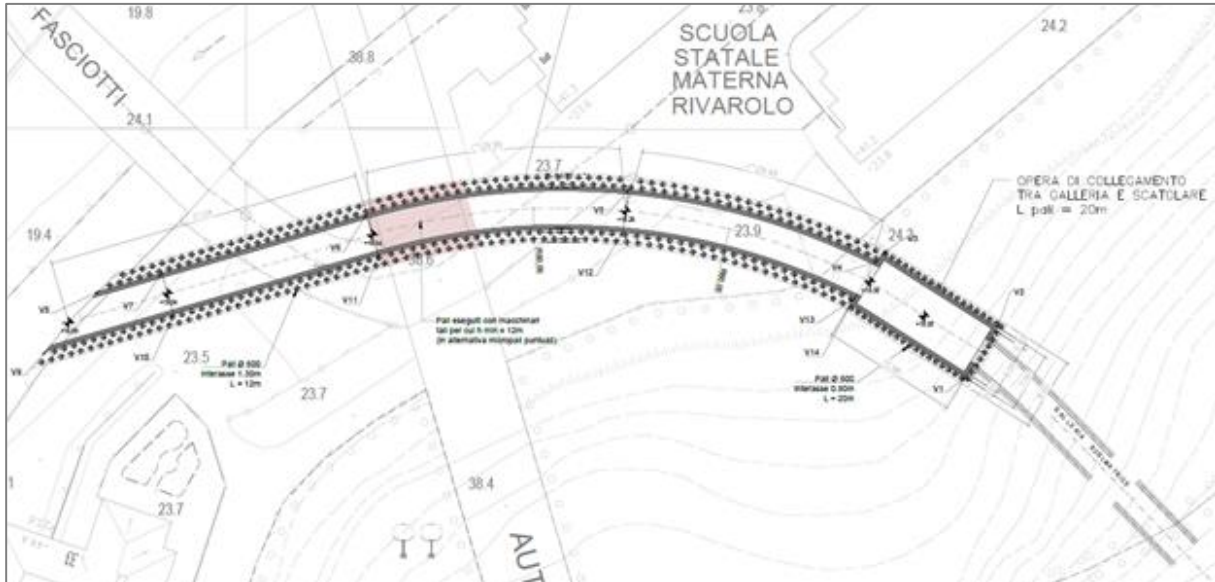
Planimetria di dettaglio dello sbocco della galleria e la connessione con lo scolare di connessione con il t. Torbella
